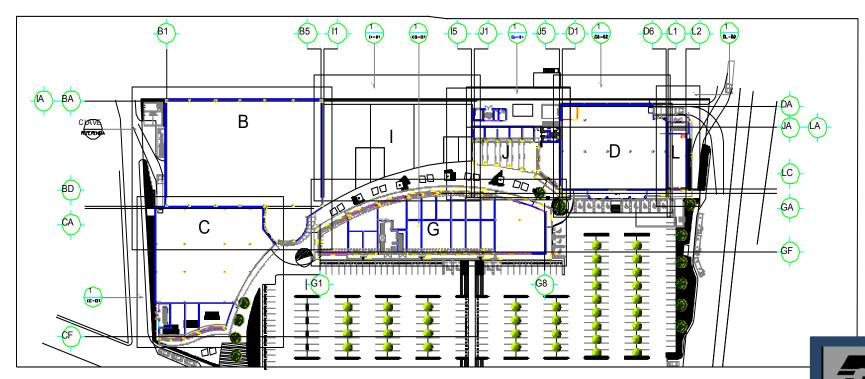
Plano zonificación general, Referencia Plano: CON- 01A.DWG
